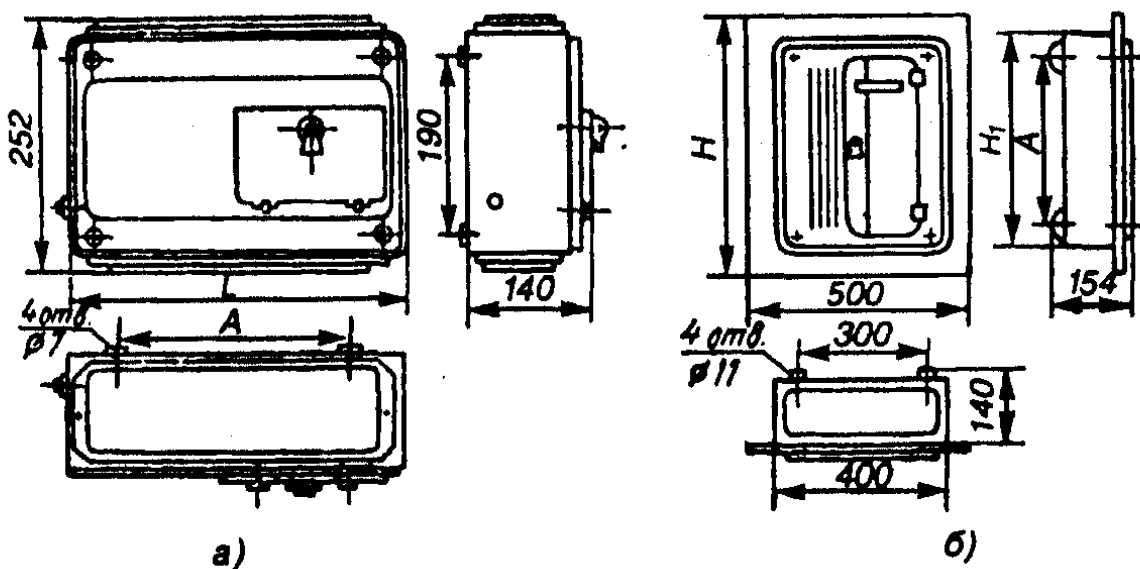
Щитки распределительные для промышленных зданий, устанавливаемые на стене (а) и в нише (б)
